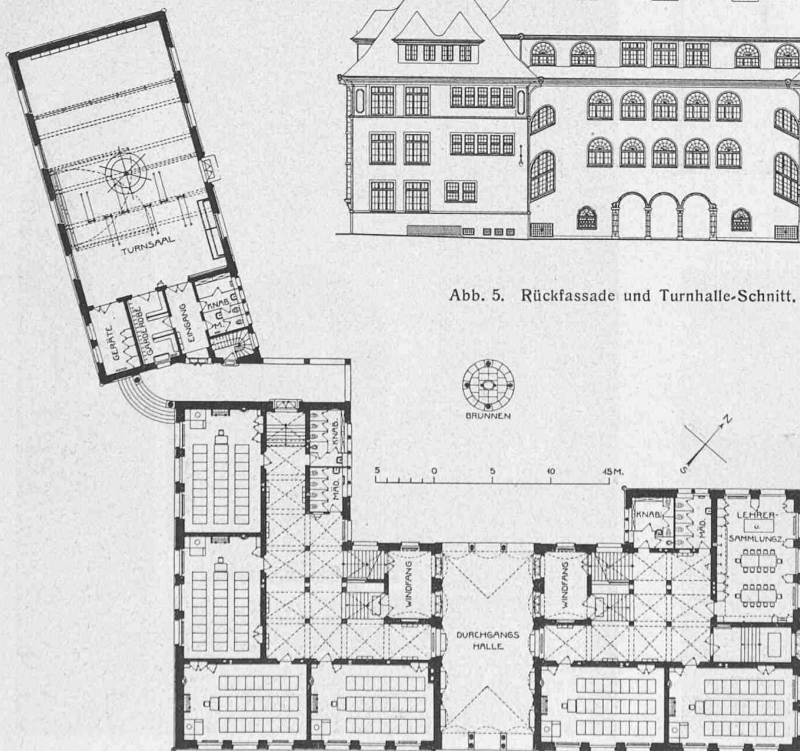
Erdgeschoss-Grundriss des Letten-Schulhauses samt Turnhalle. — 1:600.
